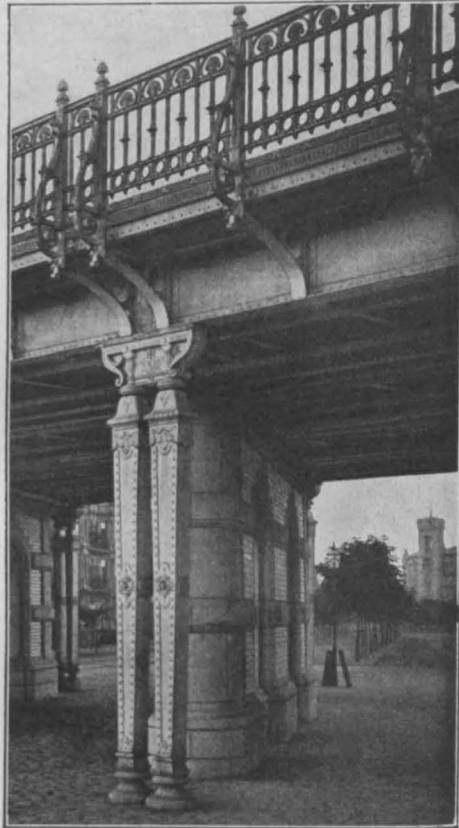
Unterführung der Straße Alt-Moabit der Berliner Stadtbahn.
